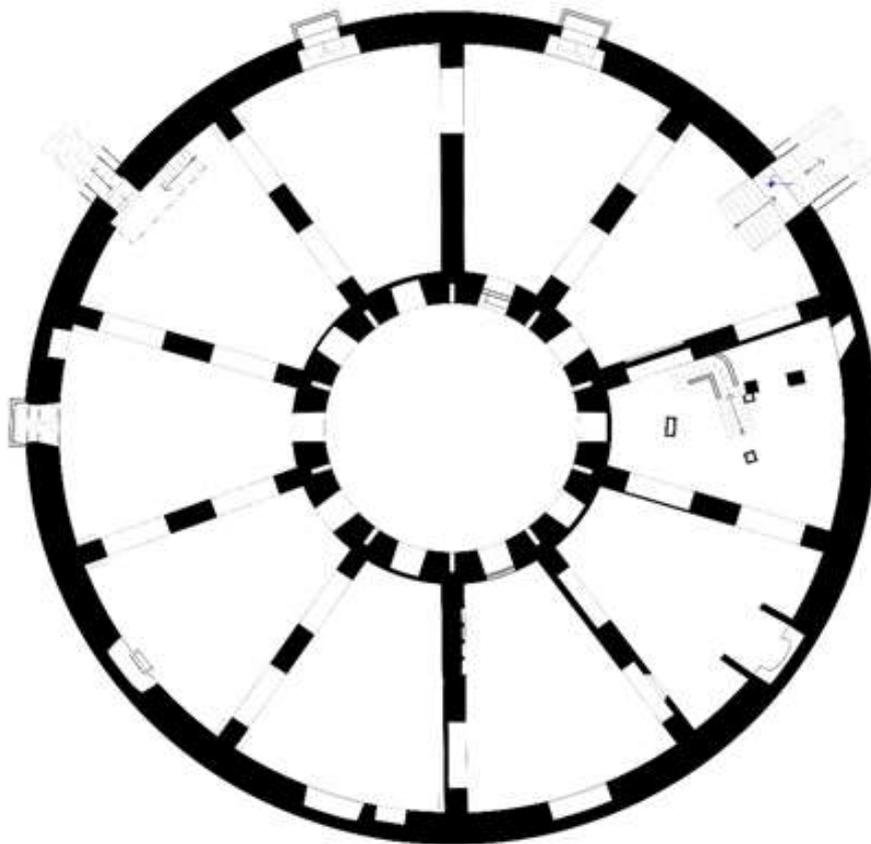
pianta piano seminterrato, stato di fatto. Rotonda.
